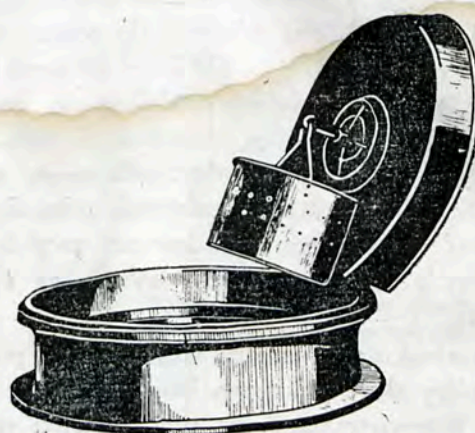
Pokrywa z wiekiem wypełnionym twardym drzewem.
